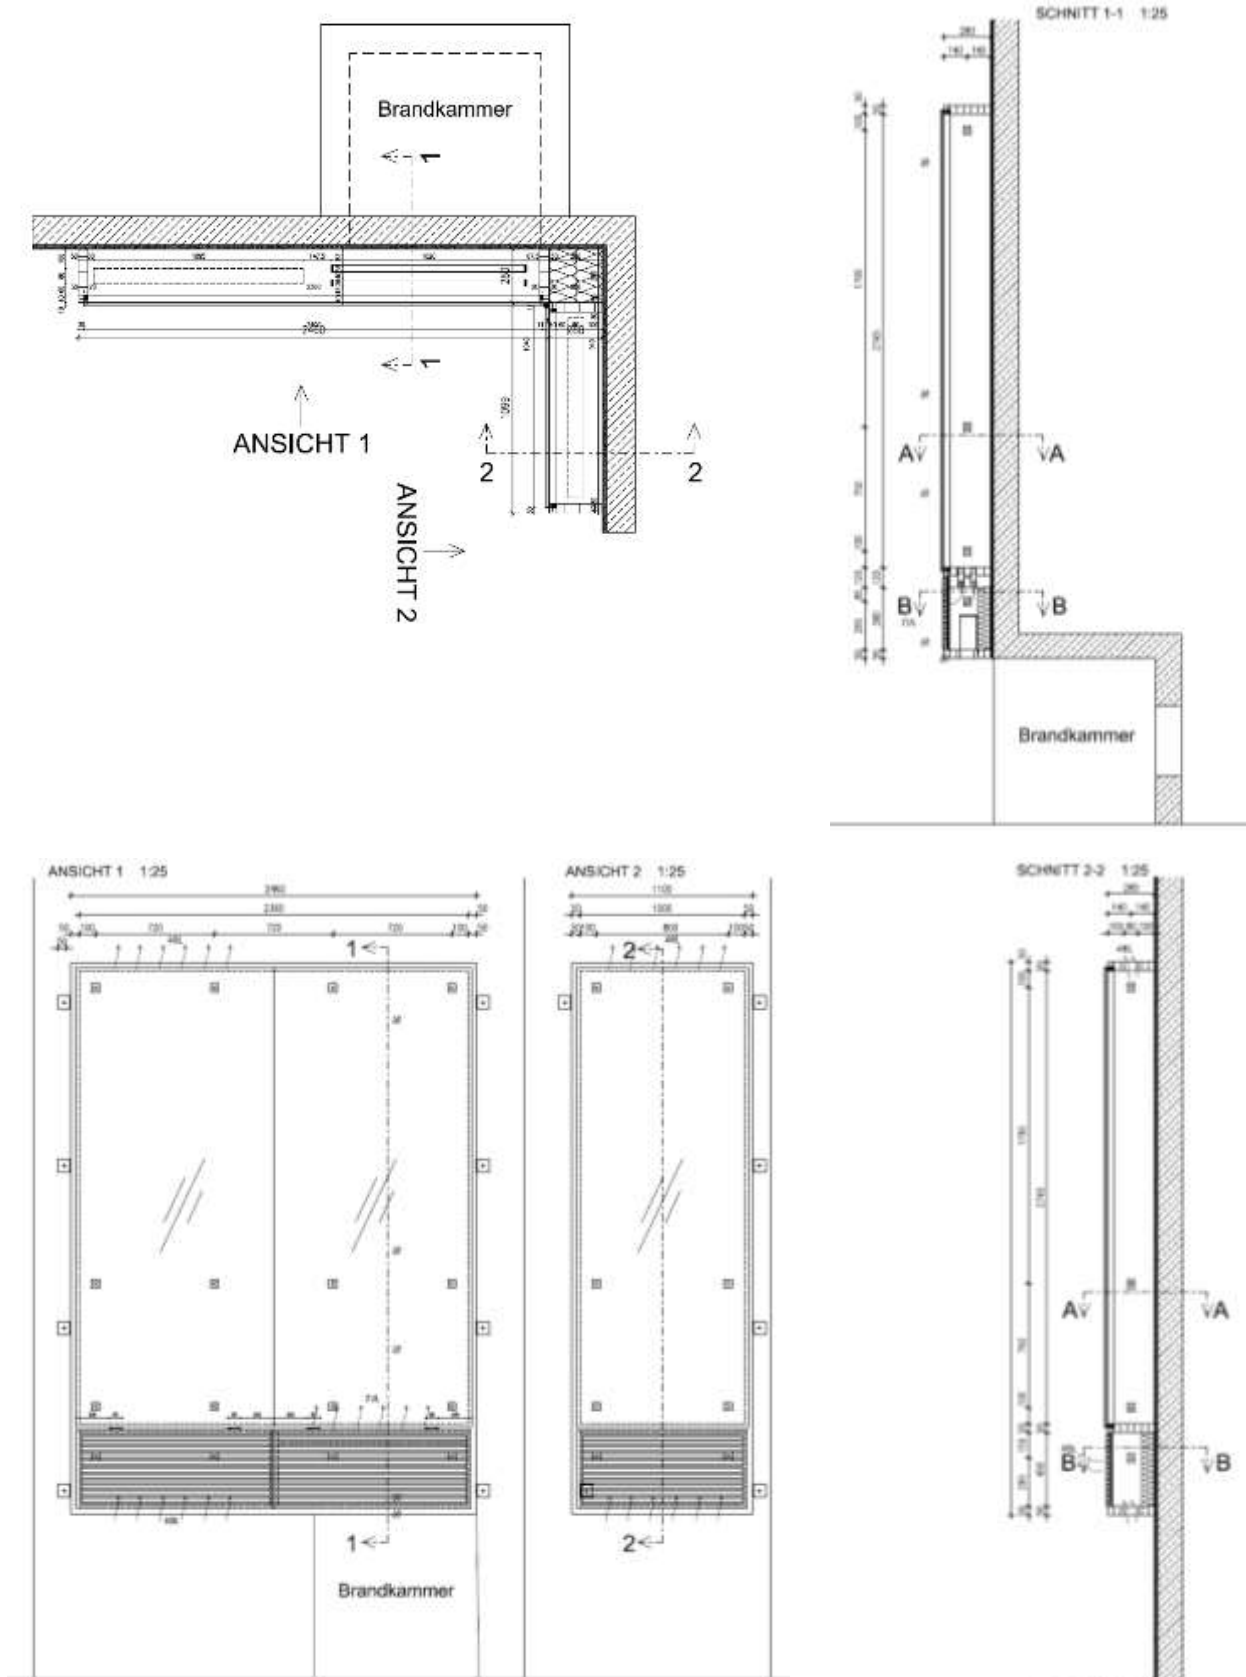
Pläne der Prüffassade P1 [eigene Darstellung]
